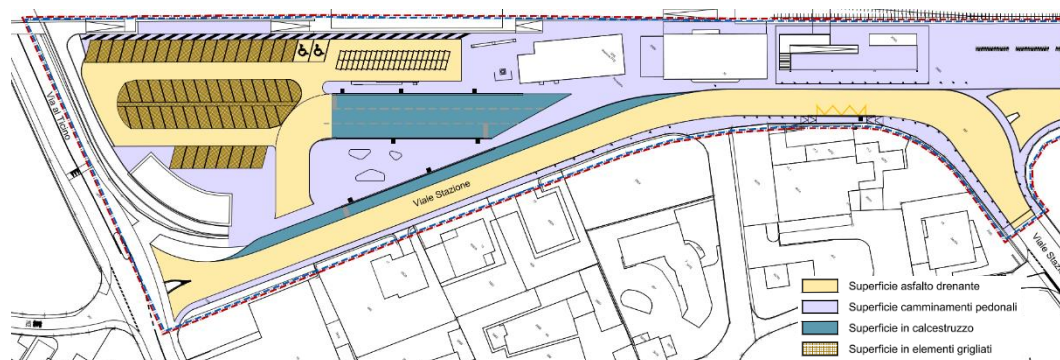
Concetto stradale di sistemazione dell'area (pavimentazione diversificata).
